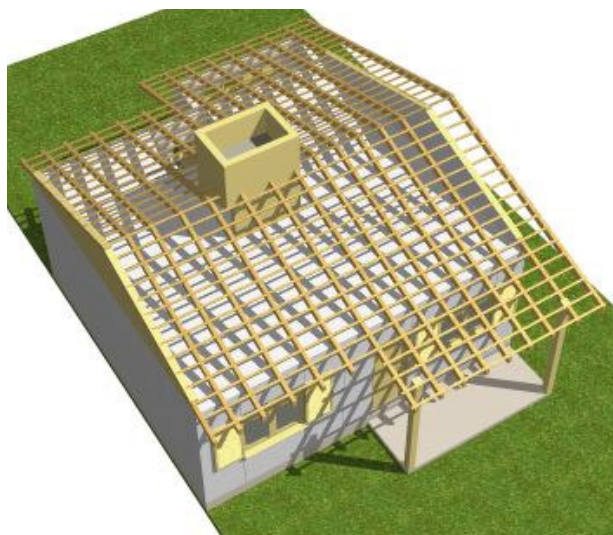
7 : montagem da estrutura de madeira da cobertura.
